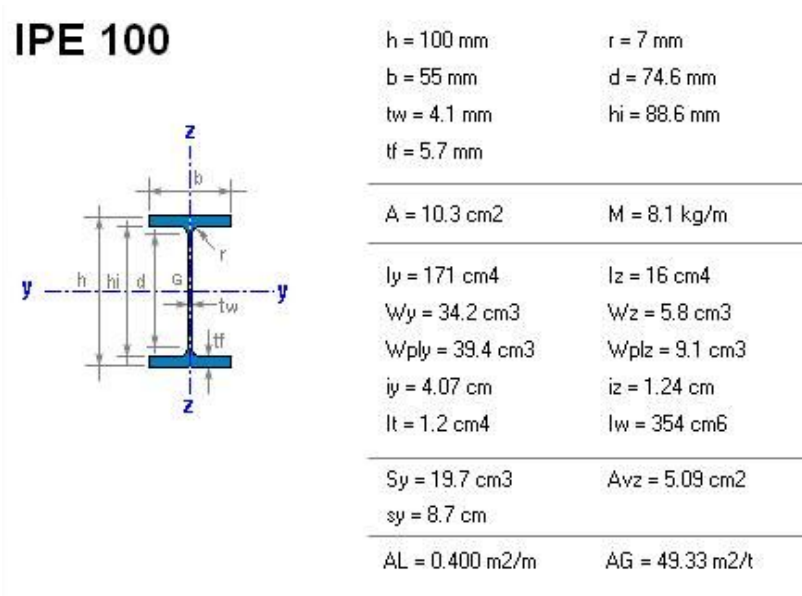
Propiedades y dimensiones de un perfil IPE 100
